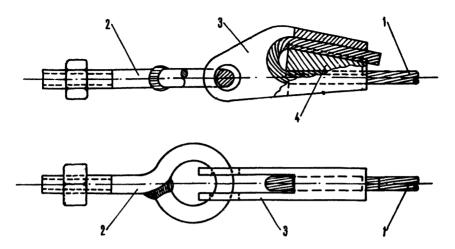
Схема присоединения прядевой арматуры к нарезному концу:
